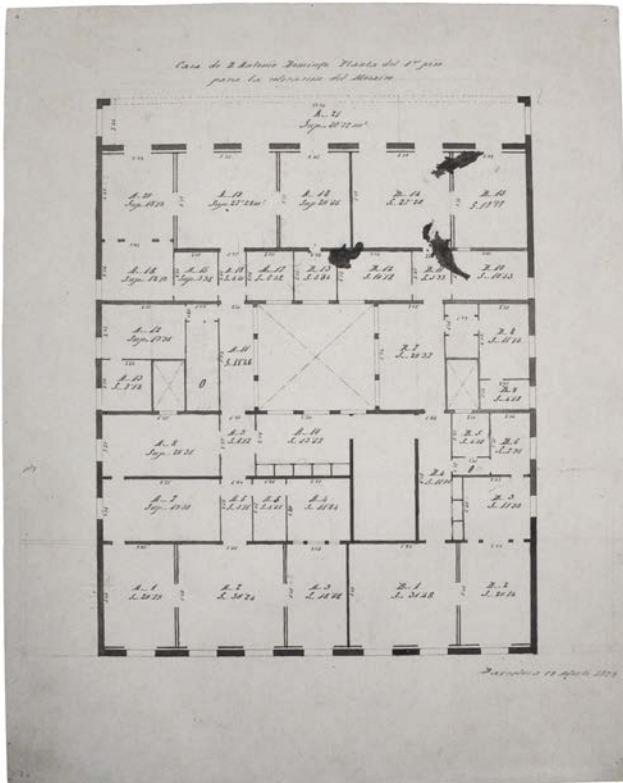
Plànol de la primera planta (casa Antoni Domingo, arquitectes Bassegoda, 1873). Font: AHCOAC H121F/5/579.
